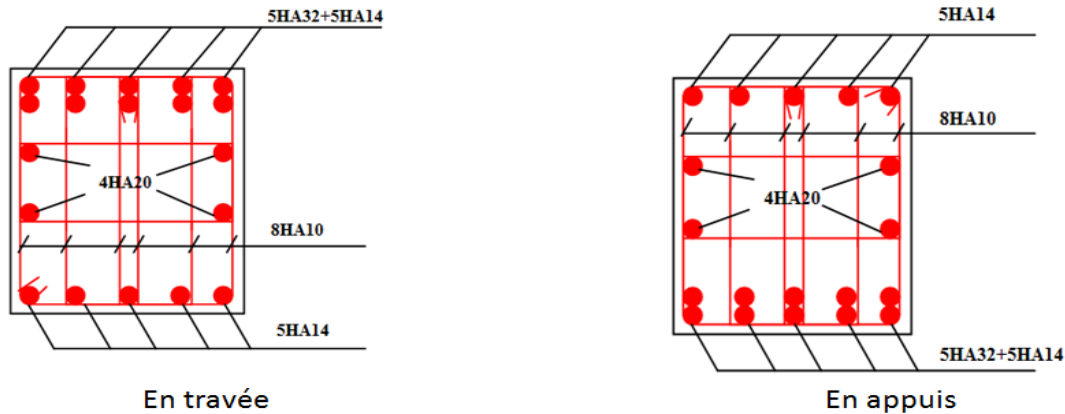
Schéma de ferrailage des nervures dans le sens (x-x)
